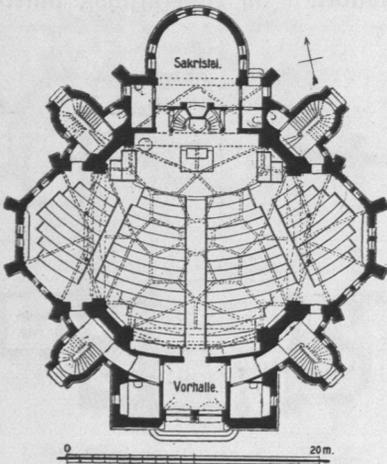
Gnadenkirche in St. Pauli, Grundriß.
